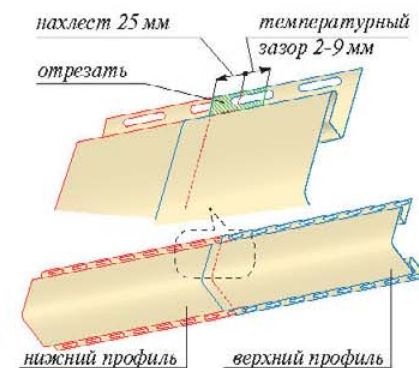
Разметка нахлеста и подрезки гвоздевых планок углового профиля
